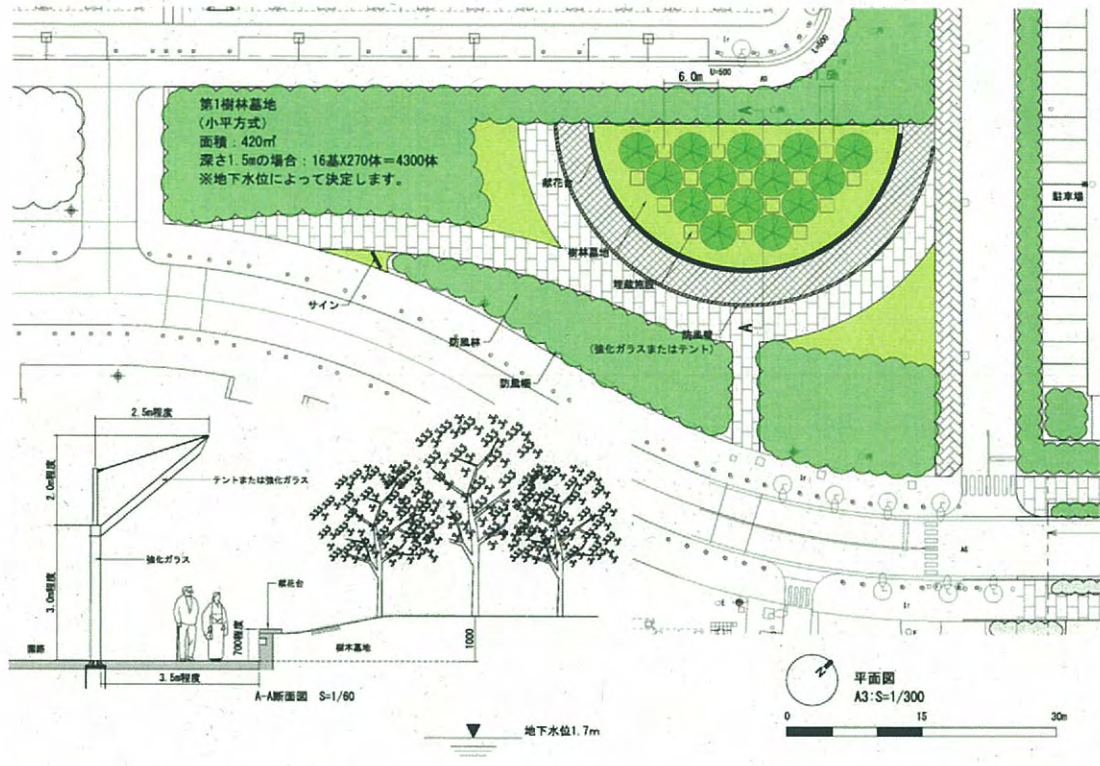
第 1 樹林墓地の平面図・立面図 (案)
